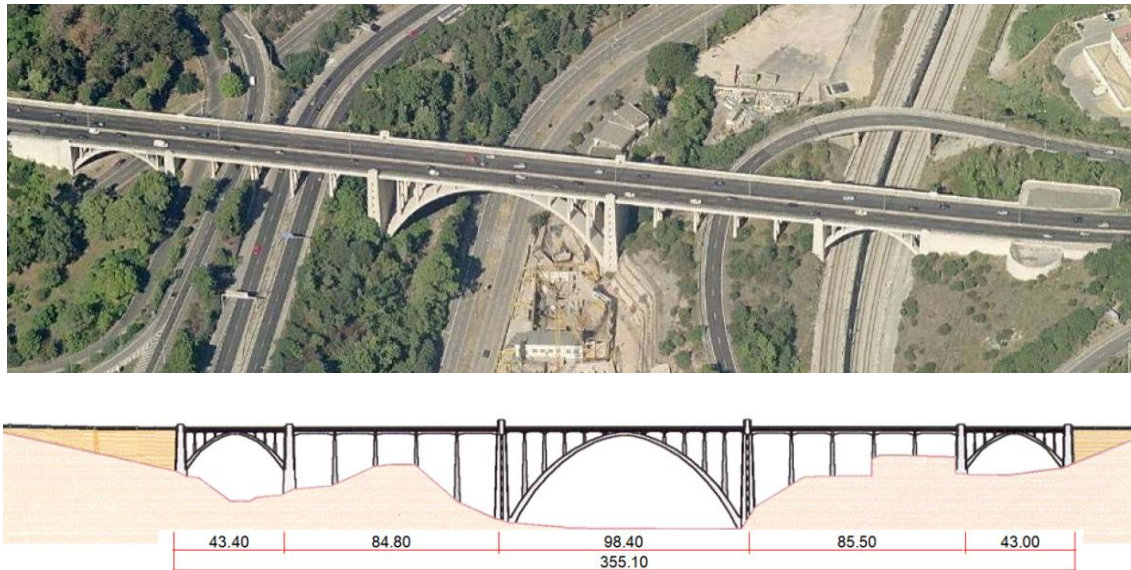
Vista do lado sul e alçado do lado norte do viaduto.
